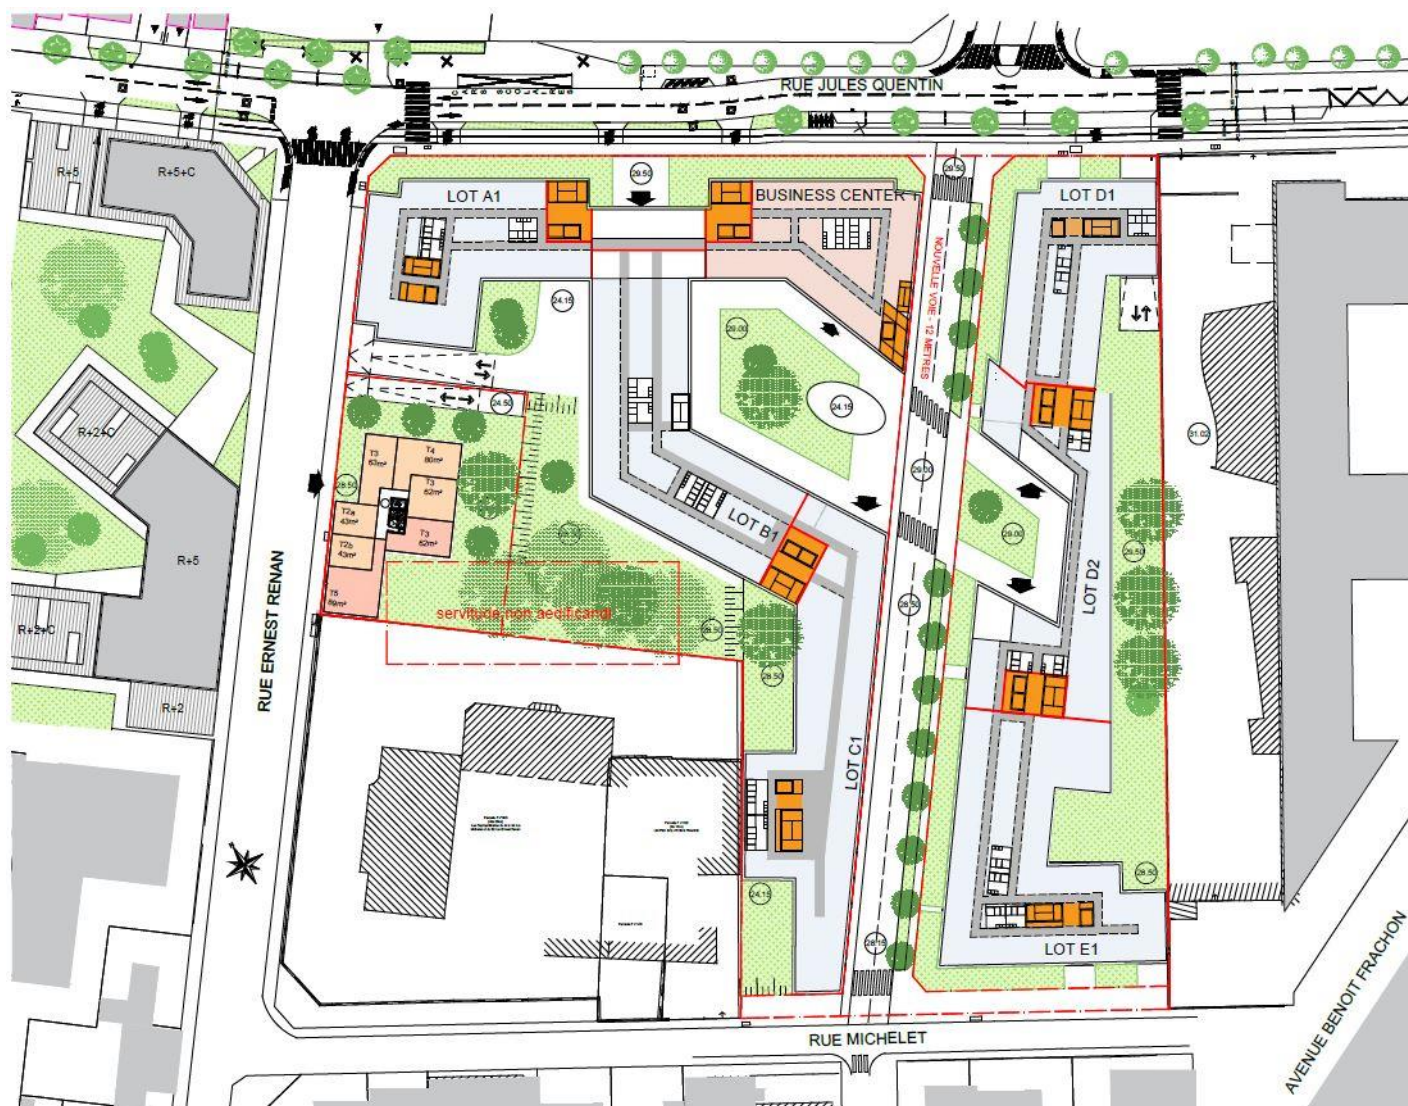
Plan du R+1 (source : CALQ, avril 2020)
